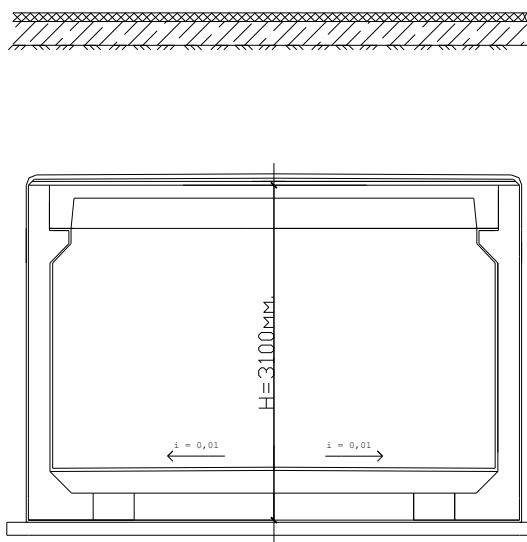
Поперечное сечение тоннеля, сборный вариант.
